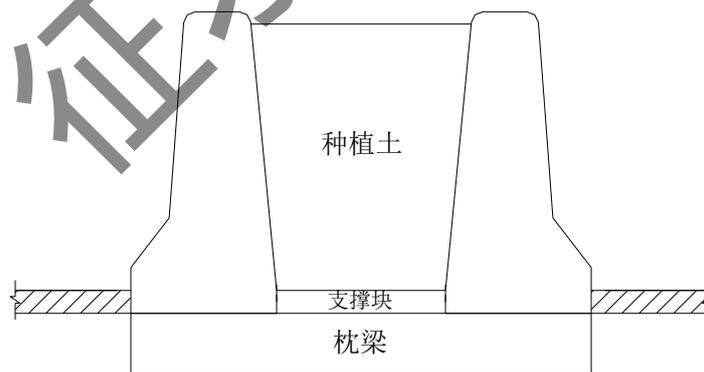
分离式中央分隔带玻璃纤维钢筋混凝土护栏构造图
